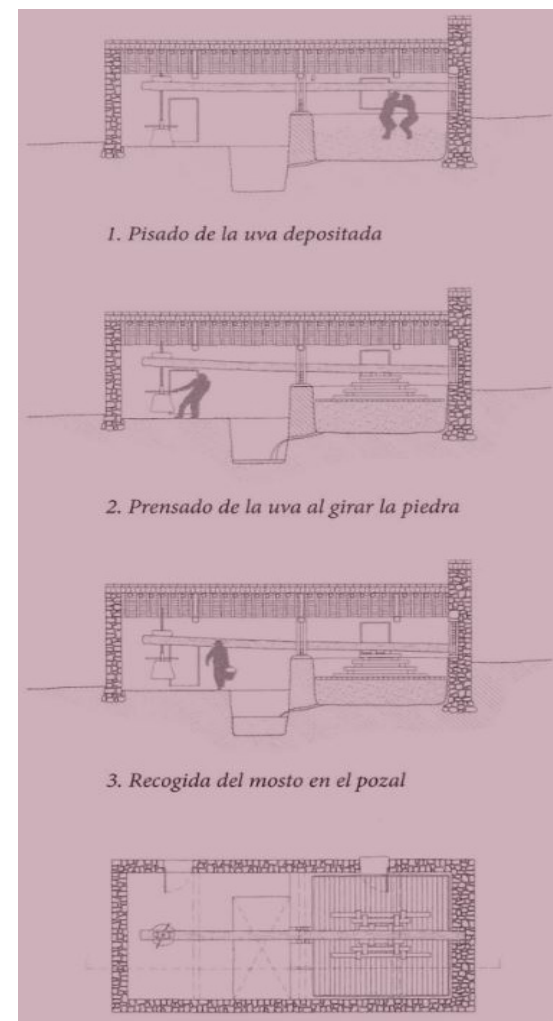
Esquema de pisado y prensado de la uva en el lagar. (Fuente: Jové, 2021).
